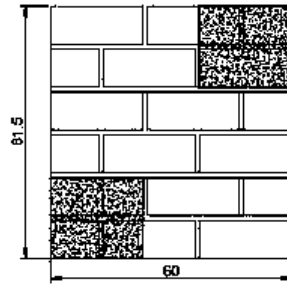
Detalle típico de muretes (Bazalar y Espinoza, 2020)
